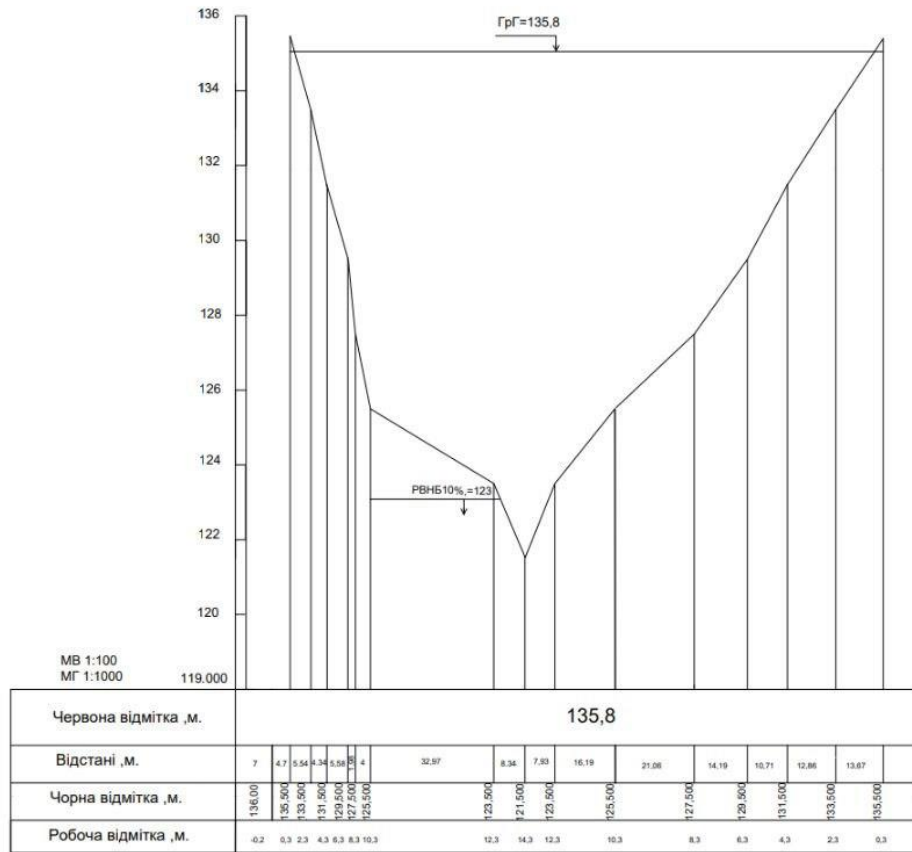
Повздовжній профіль греблі зі зняттям рослинного шару
